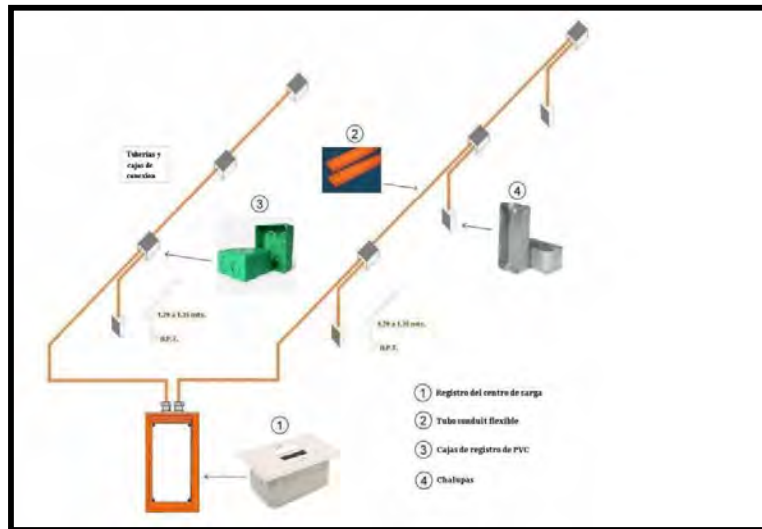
Diagrama de conexiones de las tuberías conduit [22]
